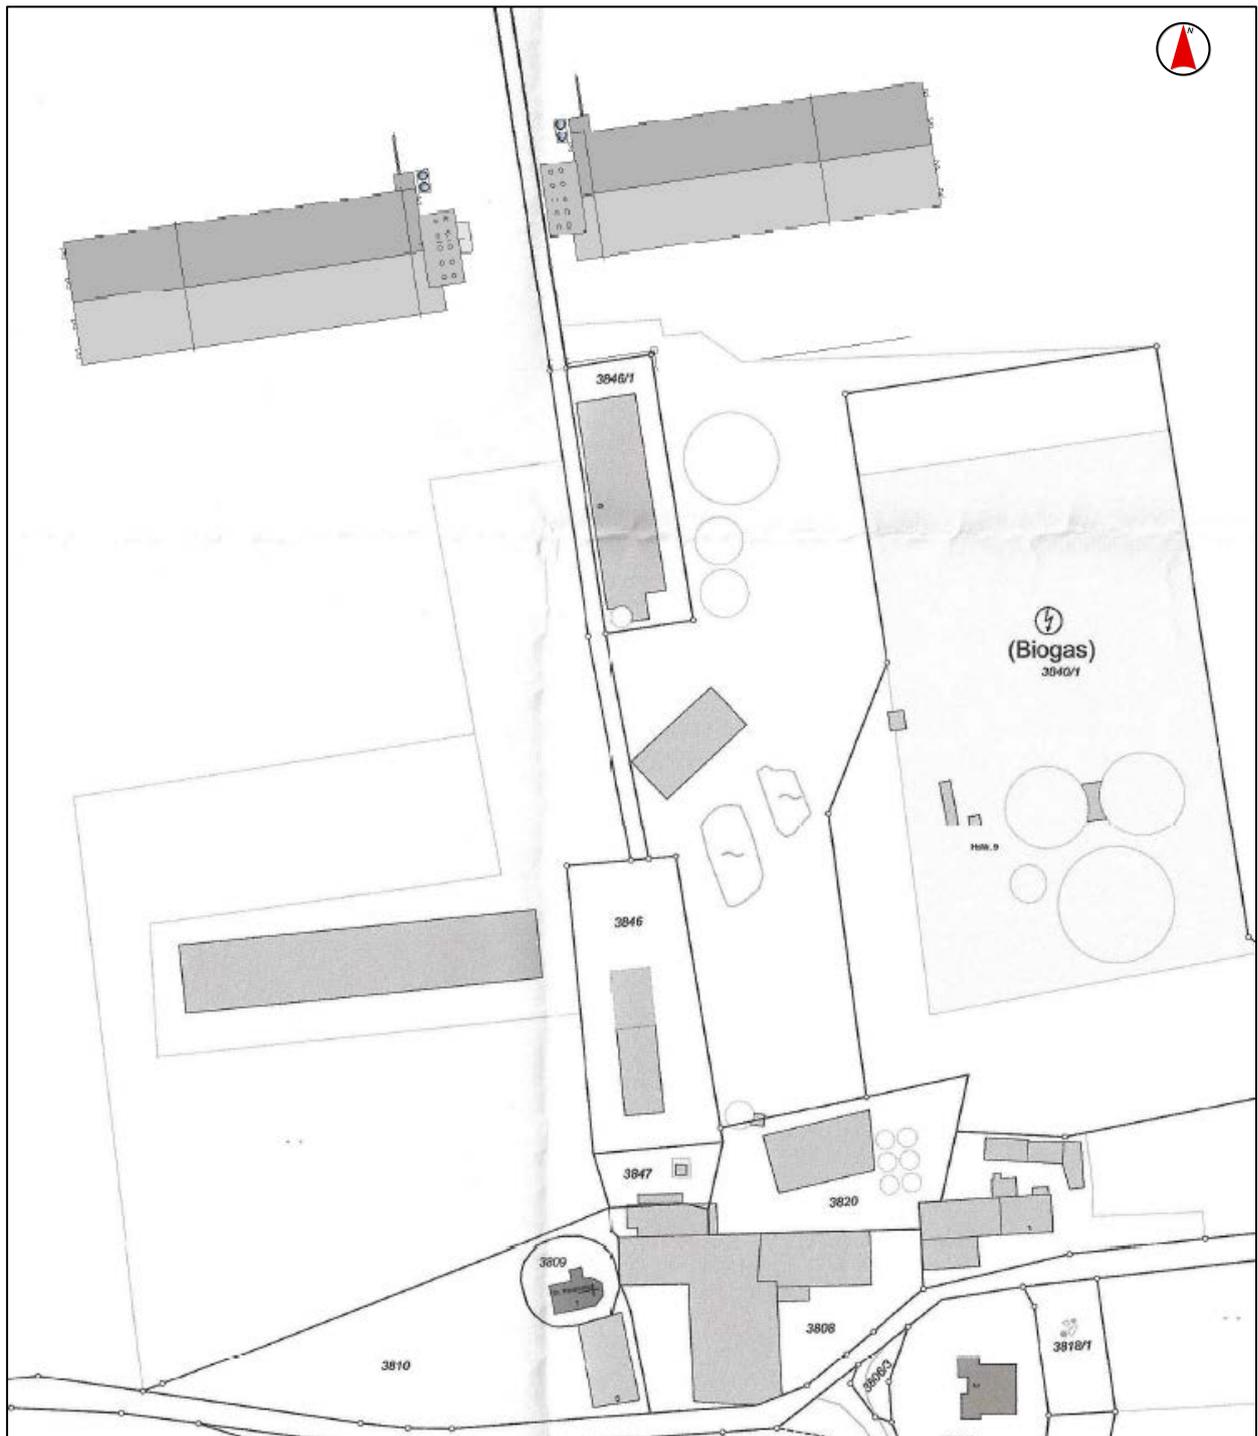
Lageplan der Tierhaltungsanlage
